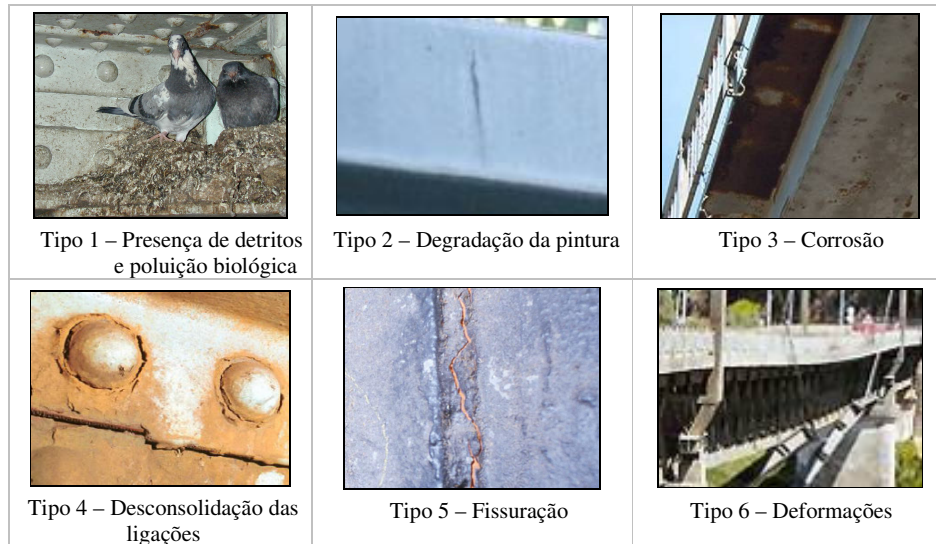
Exemplos de patologias em Obras de Arte em estrutura metálica.
